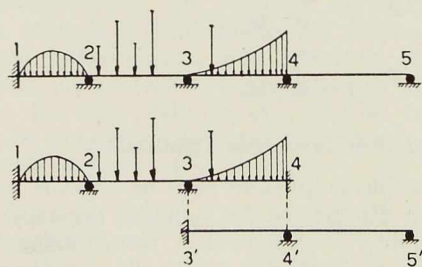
Cas d'une poutre à 4 travées dans le cas général.
